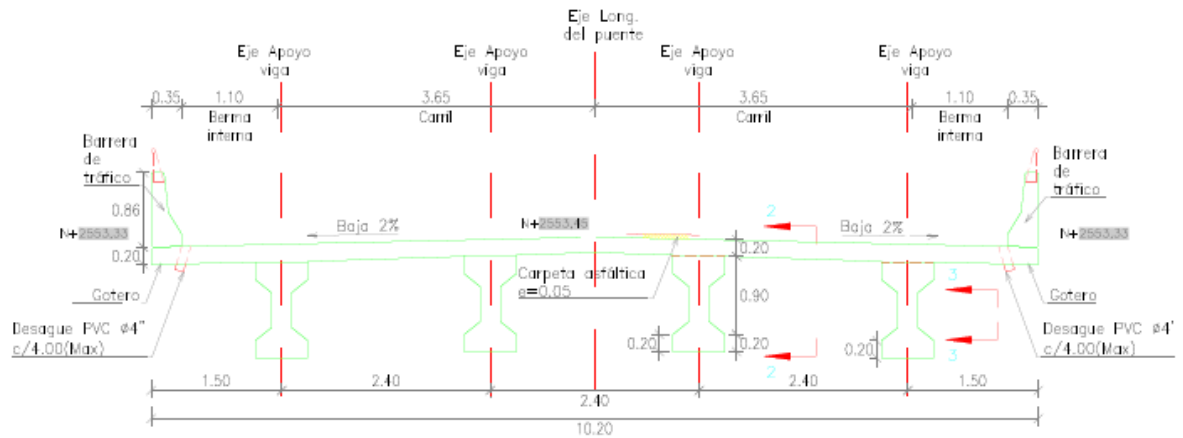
Sección transversal puente vehicular proyectado sobre el canal Torca.
